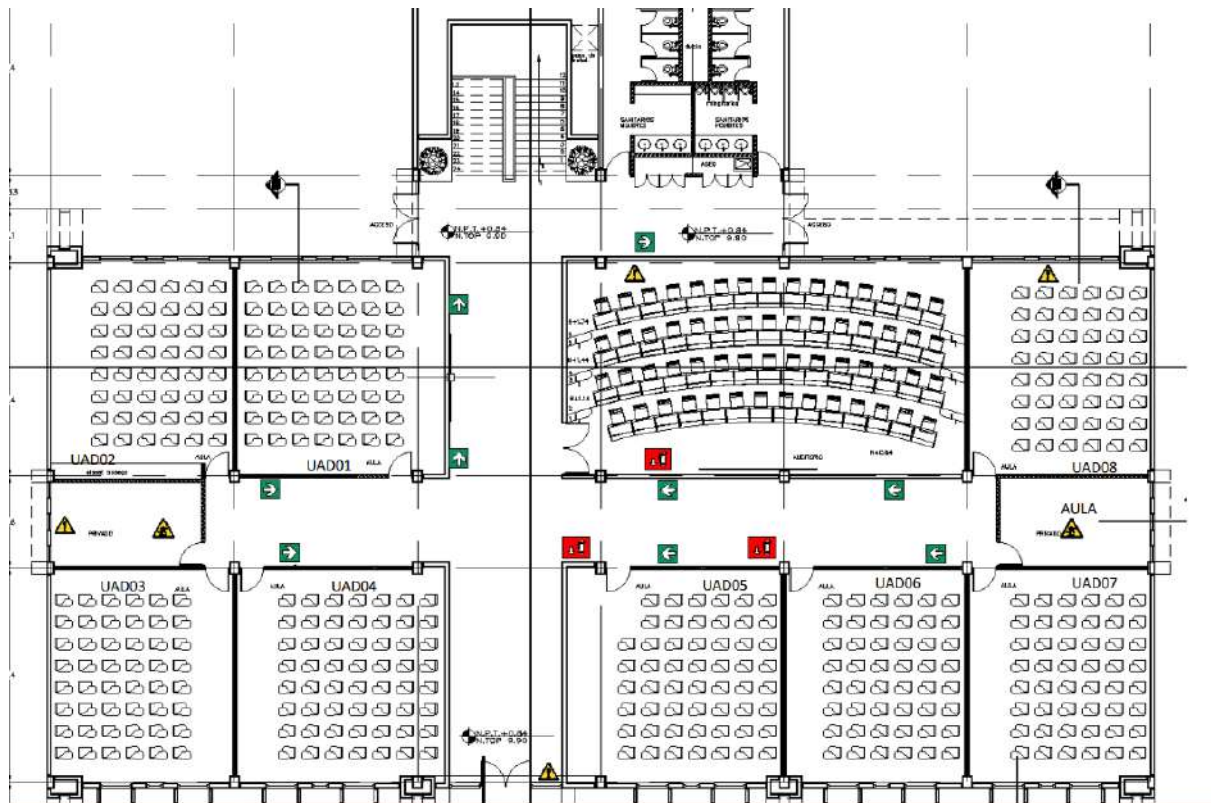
Plano edificio académico planta baja, Fuente (Canchola & Vela, 2023)
